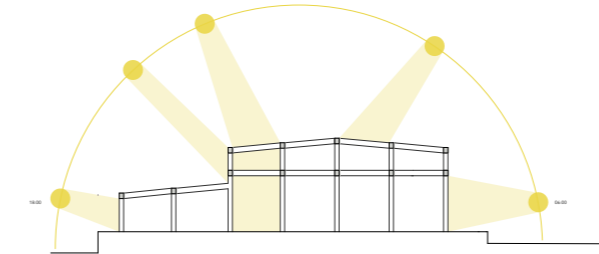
Diagrama de soleamiento en la planta de faenamiento. Fuente: Autoría propia.
